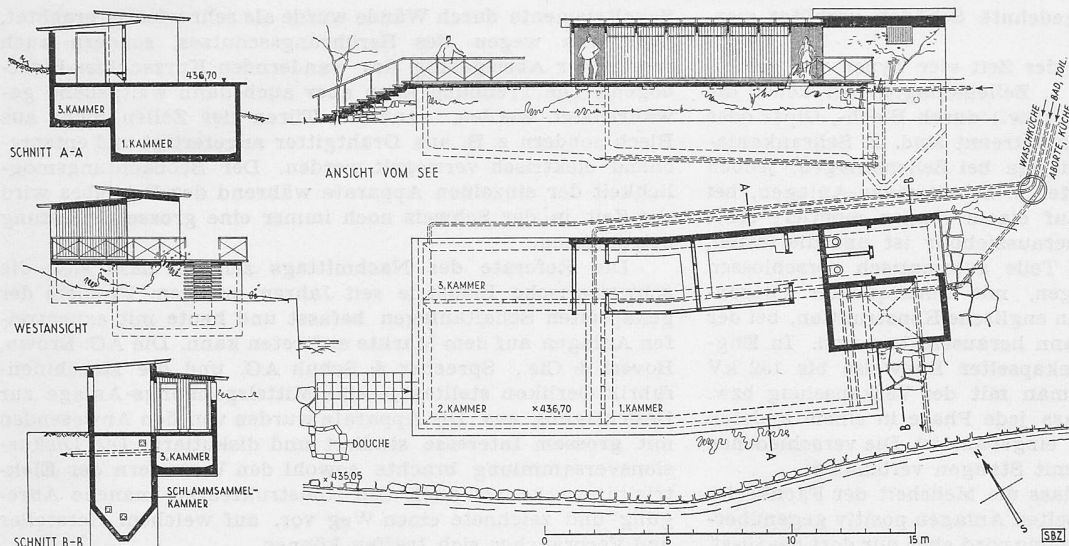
Ferienhaus Rotschuh, Kläranlage mit aufgebauten Auskleidekabinen; Grundriss und Schnitte 1: 300
